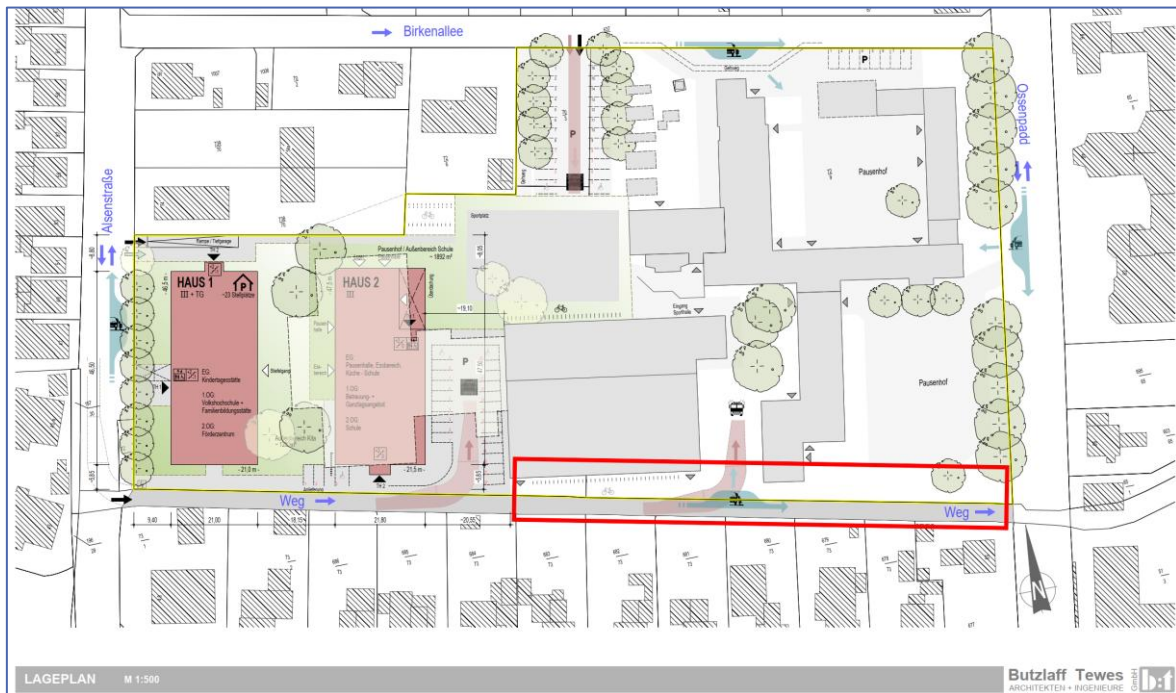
Mögliche Positionierung der Hol- und Bringzone (rot); Quelle: Lageplan Butzlaff Tewes
